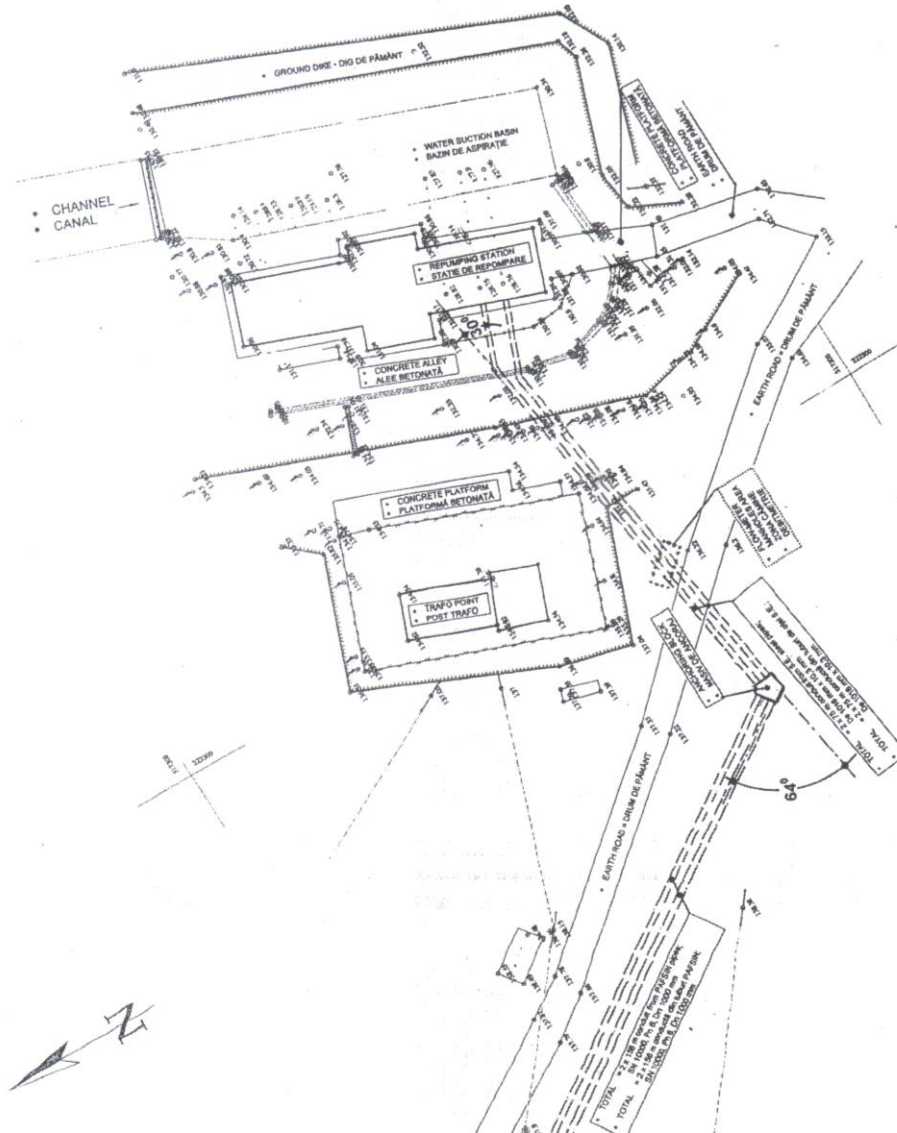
PLAN DETALIU AMPLASARE LUCRARI (FILA 2) (S.R.P.) [102]
